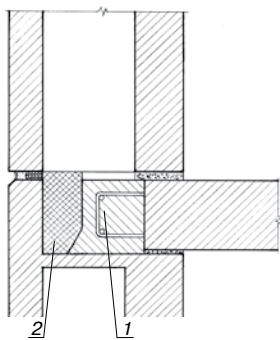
Поперечное сечение предлагаемого горизонтального стыка между продольными наружными несущими трехслойными стеновыми панелями: 1 – железобетонный монолитный пояс; 2 – теплоизоляционный вкладыш
